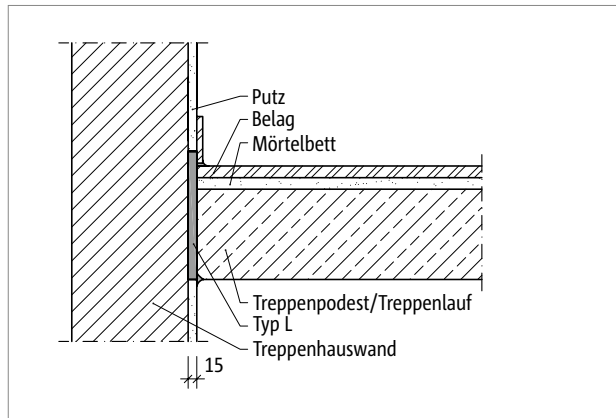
Schöck Tronsole® Typ L: Brandschutzausführung
